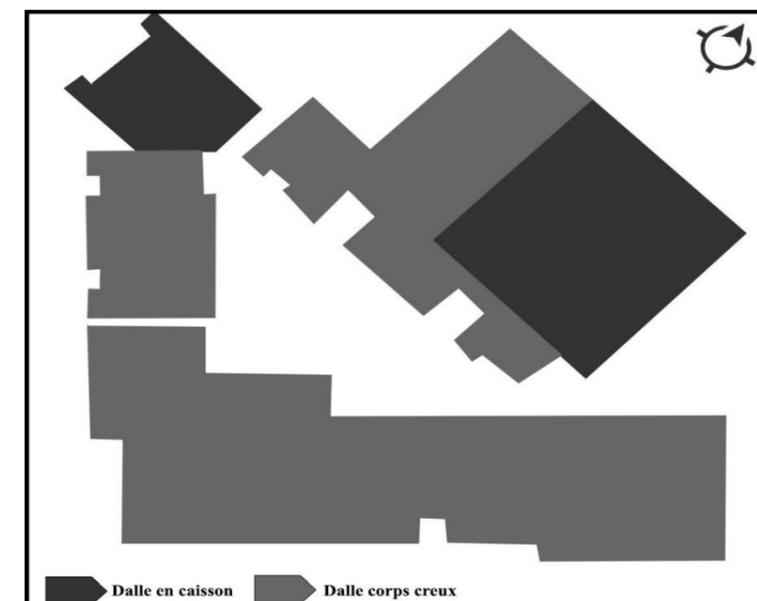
Plancher corps creux/ Source. UHBChlef - S5 Licence Génie Civil – Option : Construction Bâtiment - Cours : Bâtiment 1 - Prof. Amar KASSOUL
